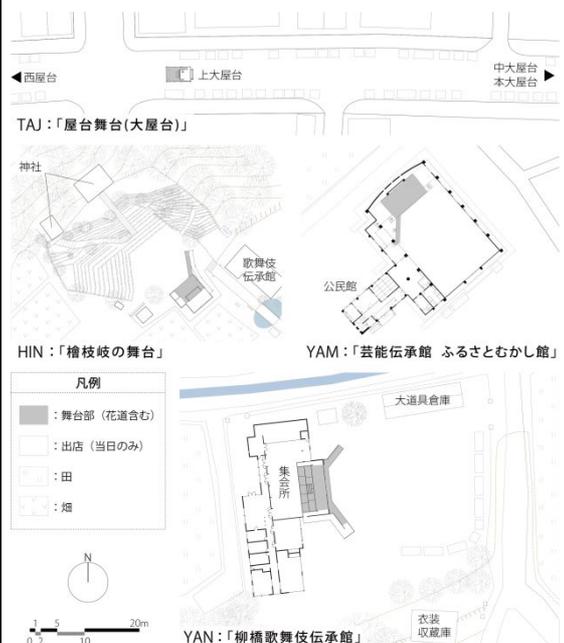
福島県内に現存する地歌舞伎・舞台建築の配置図兼平面図
